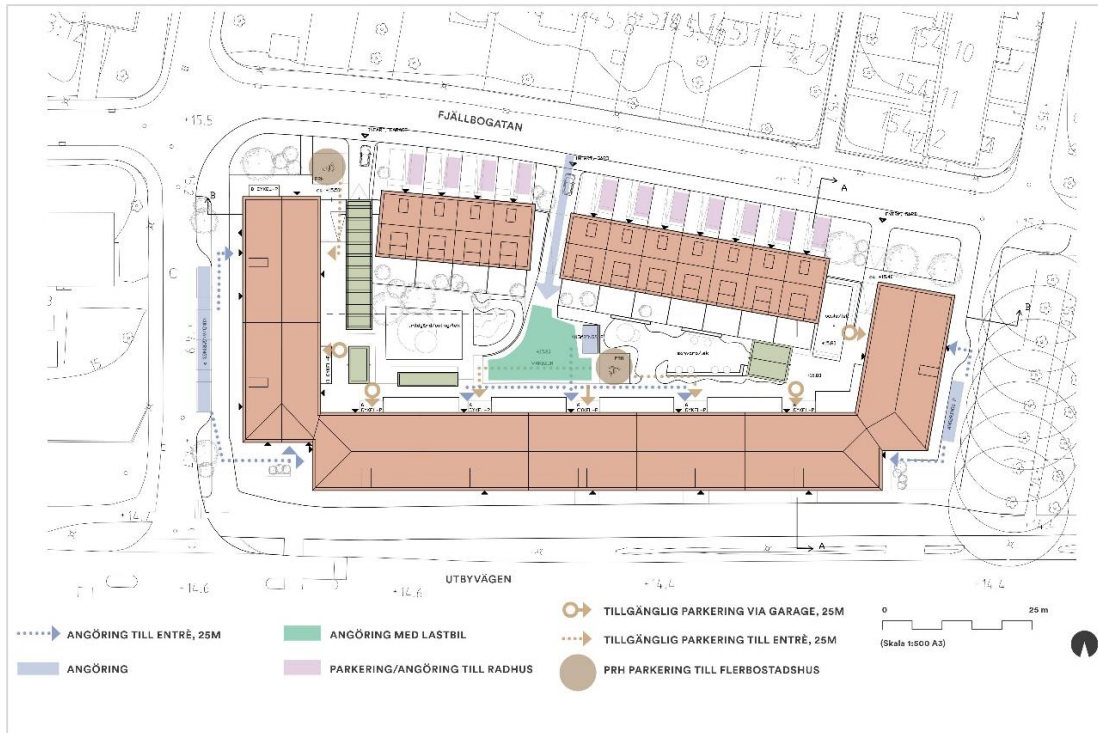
Föreslagen planlösning entréplan (Okidoki, 2023-12-21).
